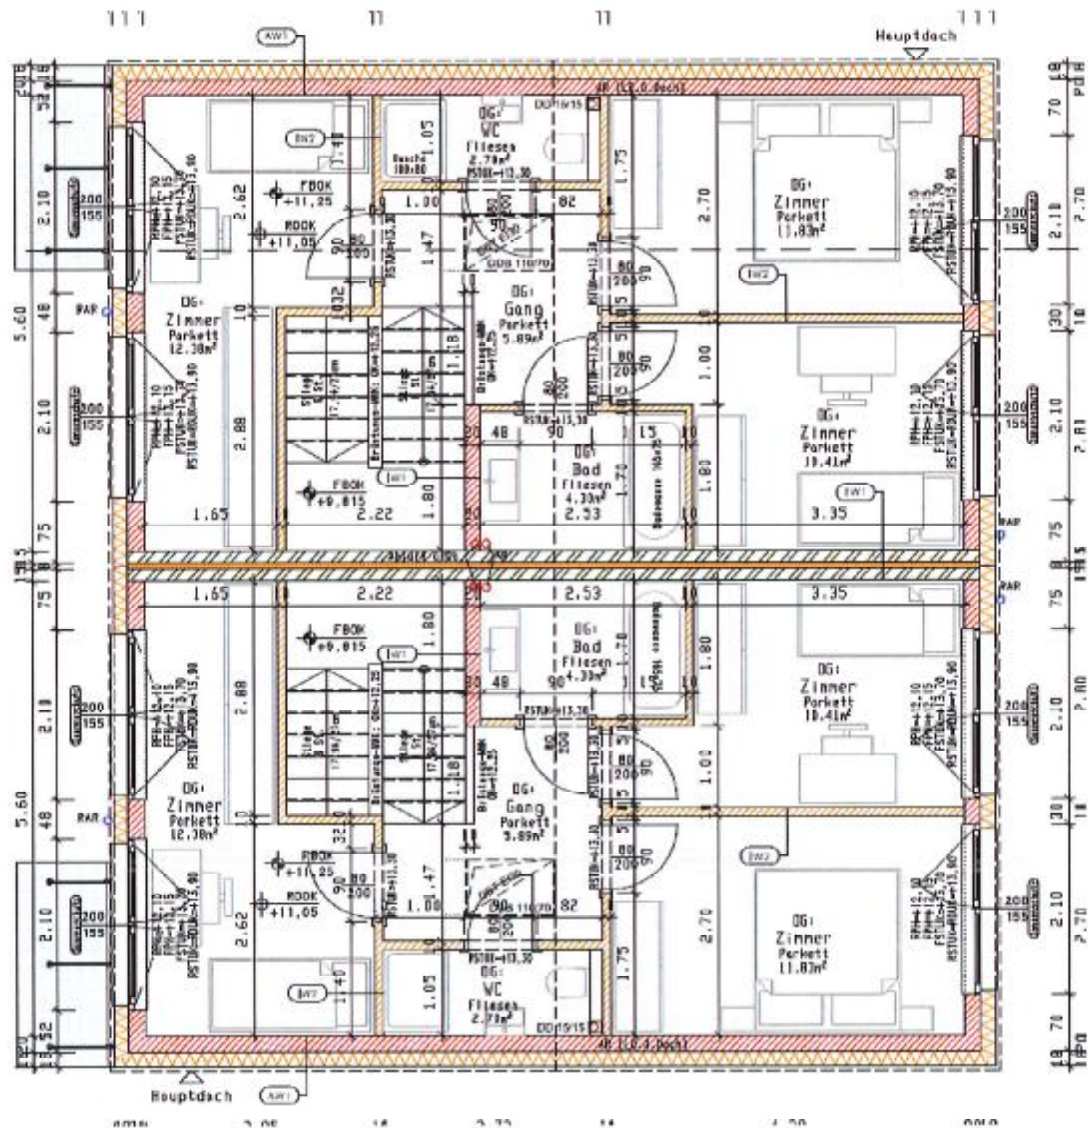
Grundriss Obergeschoß Doppelhaus 3 | Ing. Rupert Weber | 23.11.2020
